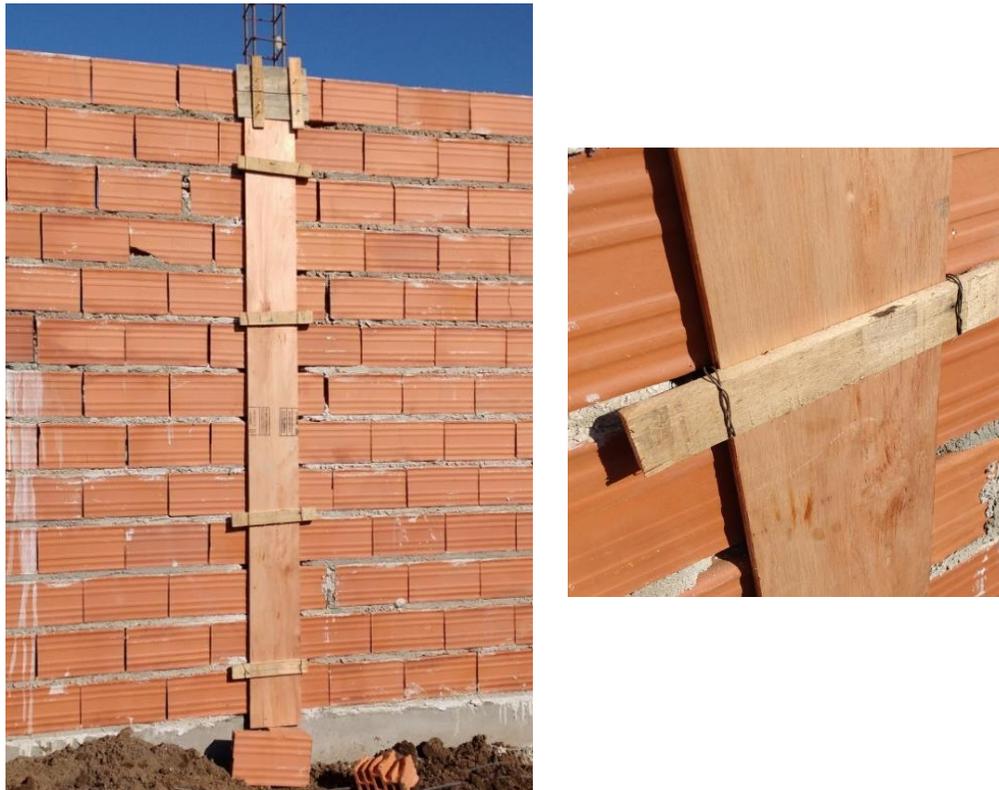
Armado de encofrados entre muros – Detalle de brida de amarre
